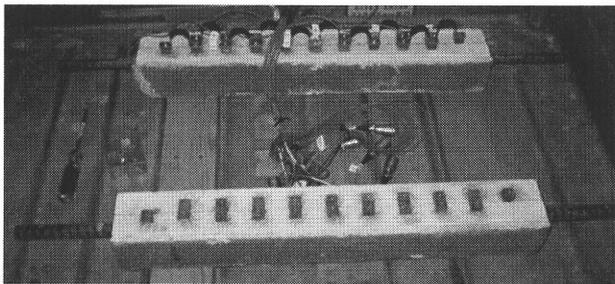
ひび割れ追従試験体 (引張試験体) 写真
